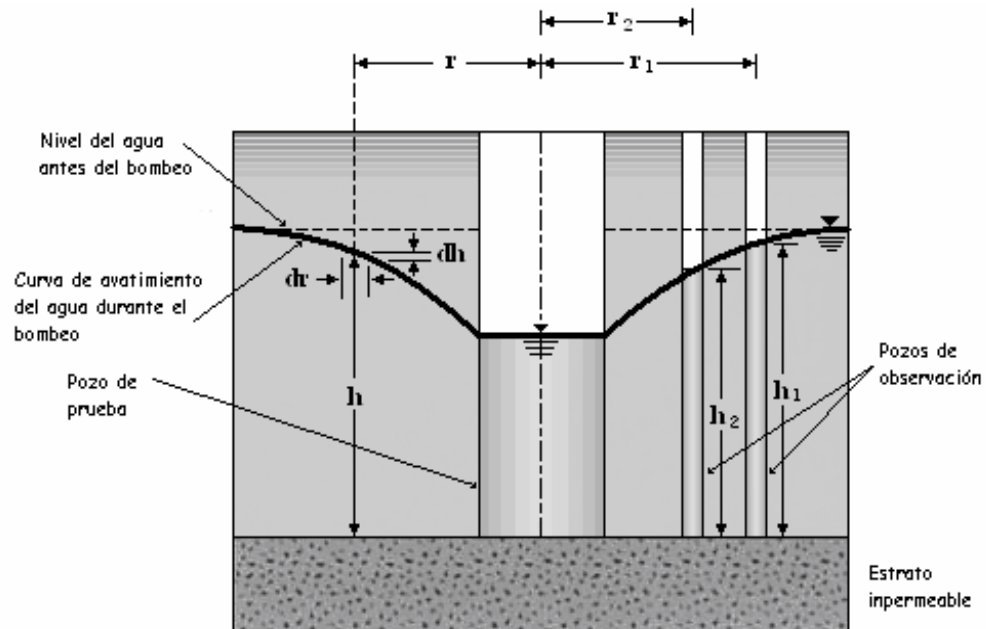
Prueba de bombeo en estrato permeable no confinado sobre estrato impermeable para la determinación de la permeabilidad del suelo en campo.
